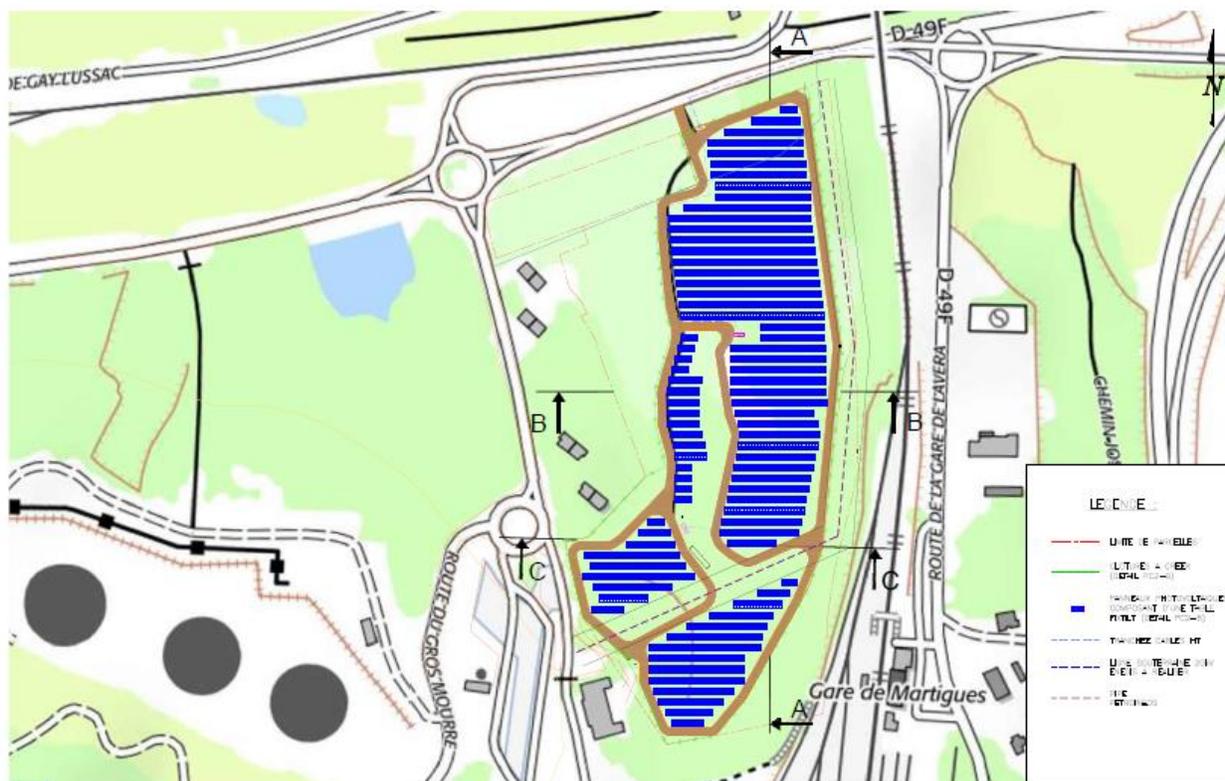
Plan de masse final du projet de centrale photovoltaïque au sol (Source : Plan de permis)
